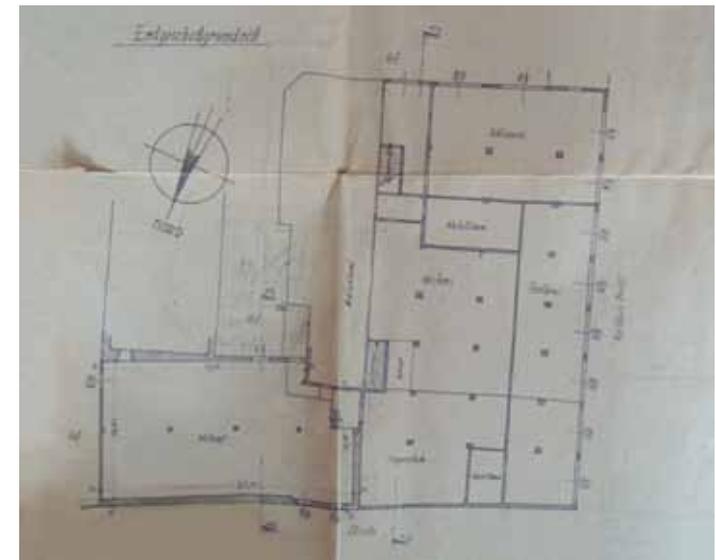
Grundriss von Shed II und des zugebauten Websaales, 1962
